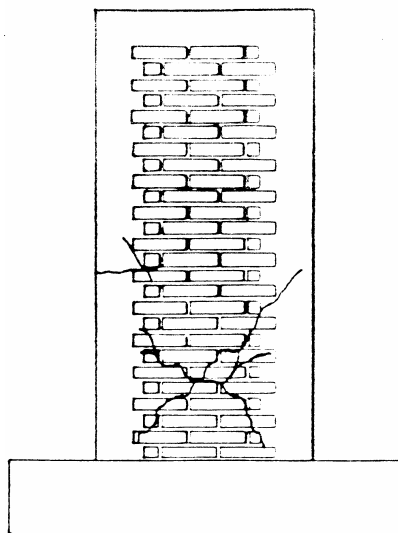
Estado agrietado de muro MRE2 (Diez, 1987)
